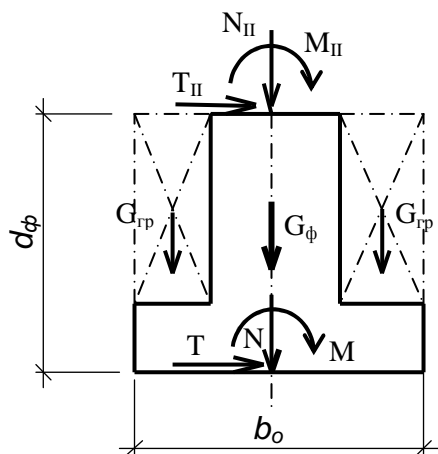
Окончательная расчетная схема фундамента на естественном основании
